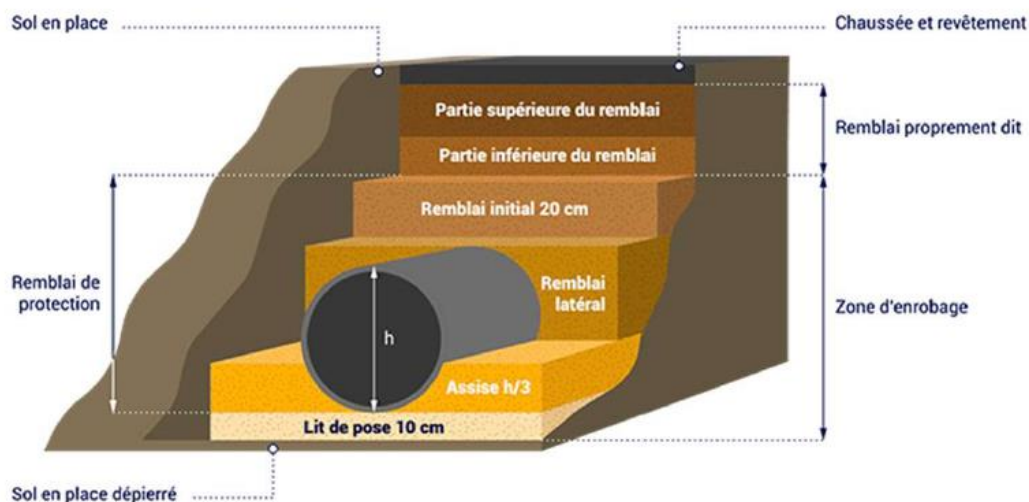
Coupe de principe d'une canalisation béton enterrée
